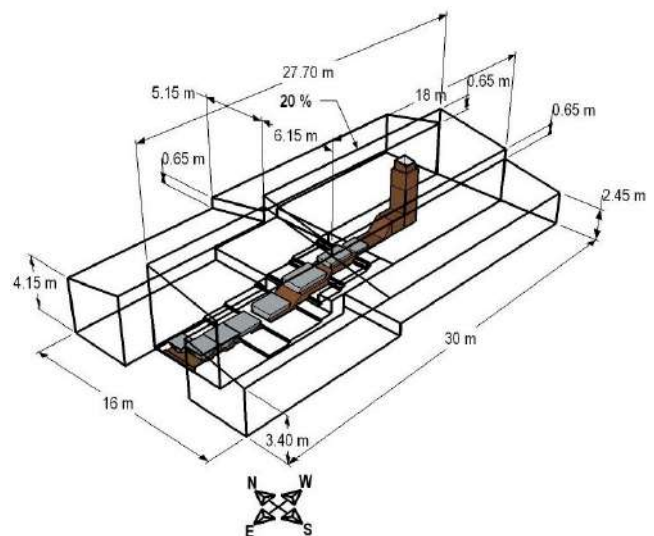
Dimensiones del trapiche panelero. Fuente: Elaboración autores
